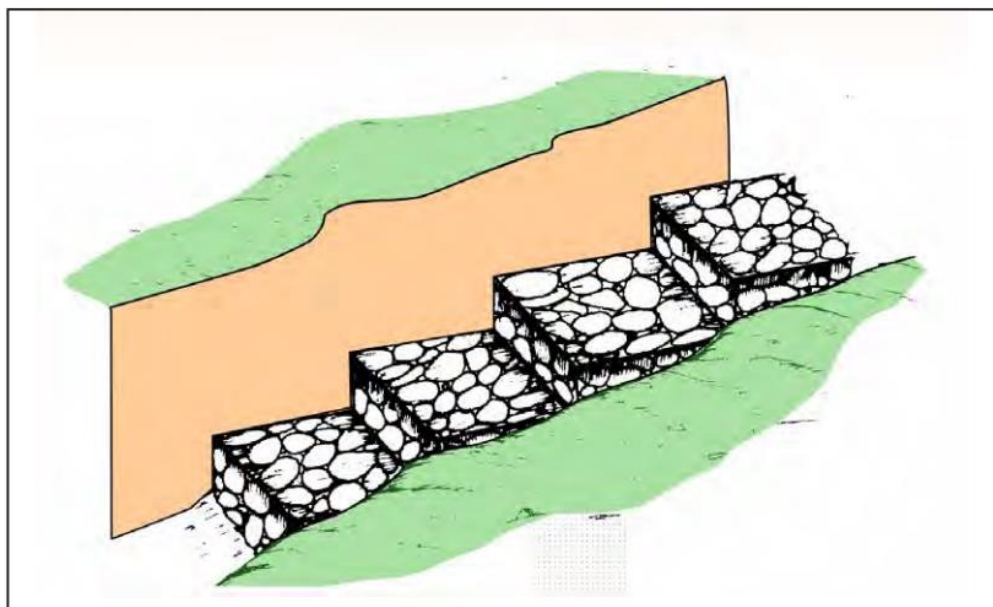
Protección del lecho de la quebrada con muros escalonados (andenes), utilizando bloques de roca o concreto armado.
